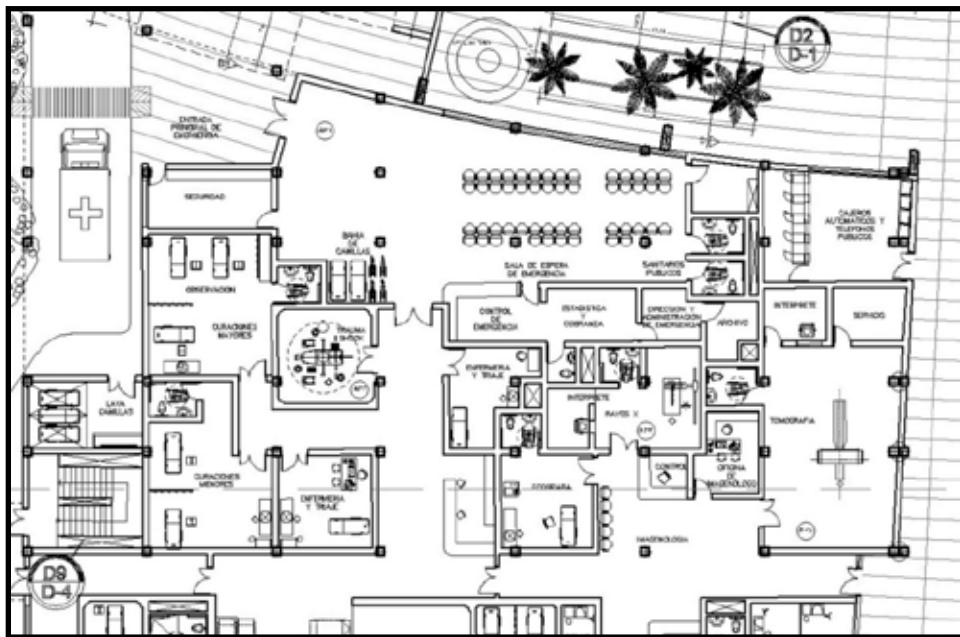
Planta Baja Ala-2 Emergencia de la Unidad de Caumatología.
